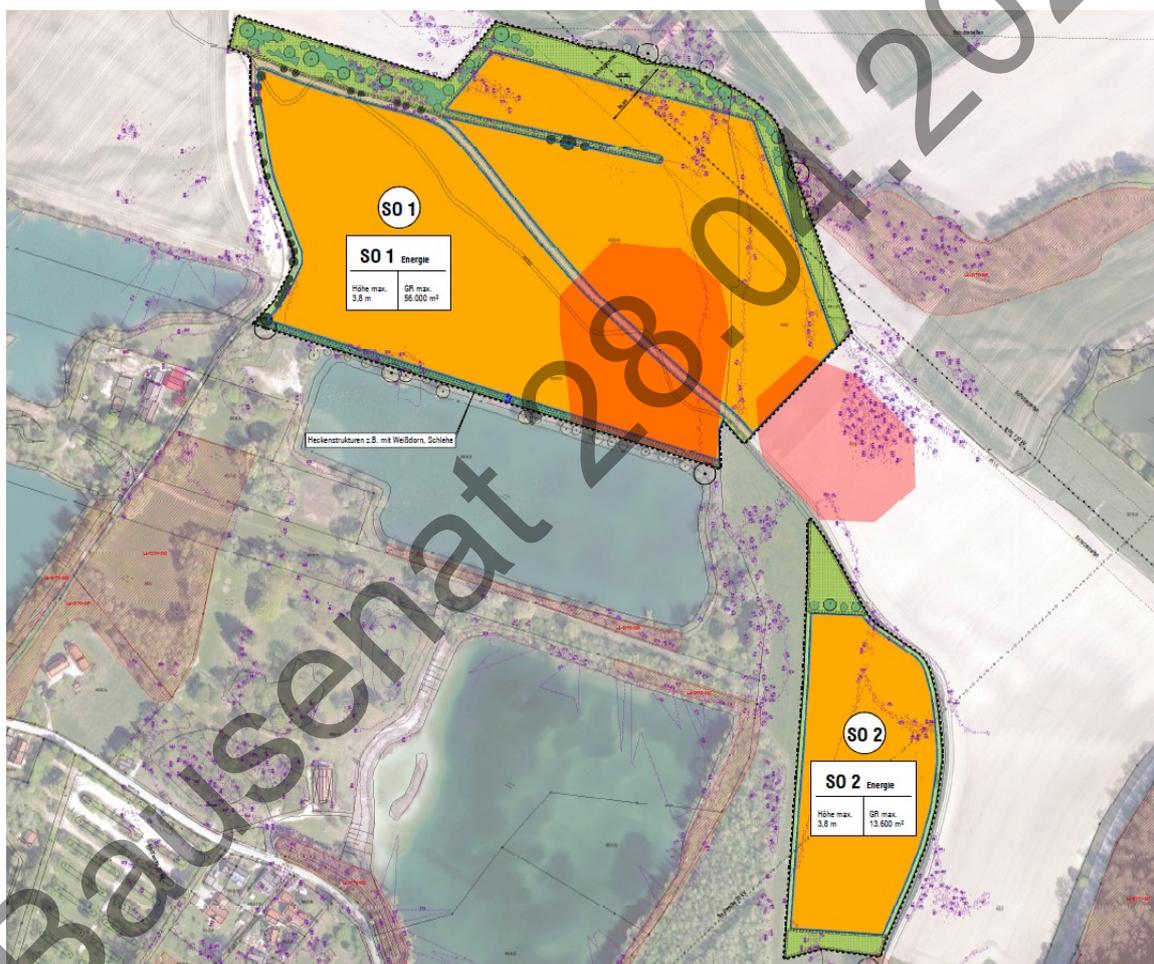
Lage des geplanten Solarparks - Quelle: Stefan Längst Bebauungsplan Bebauungsplan 07-86- Solarpark Gretlmühle Stand: Konzeptentwurf vom 4.10.2021)
